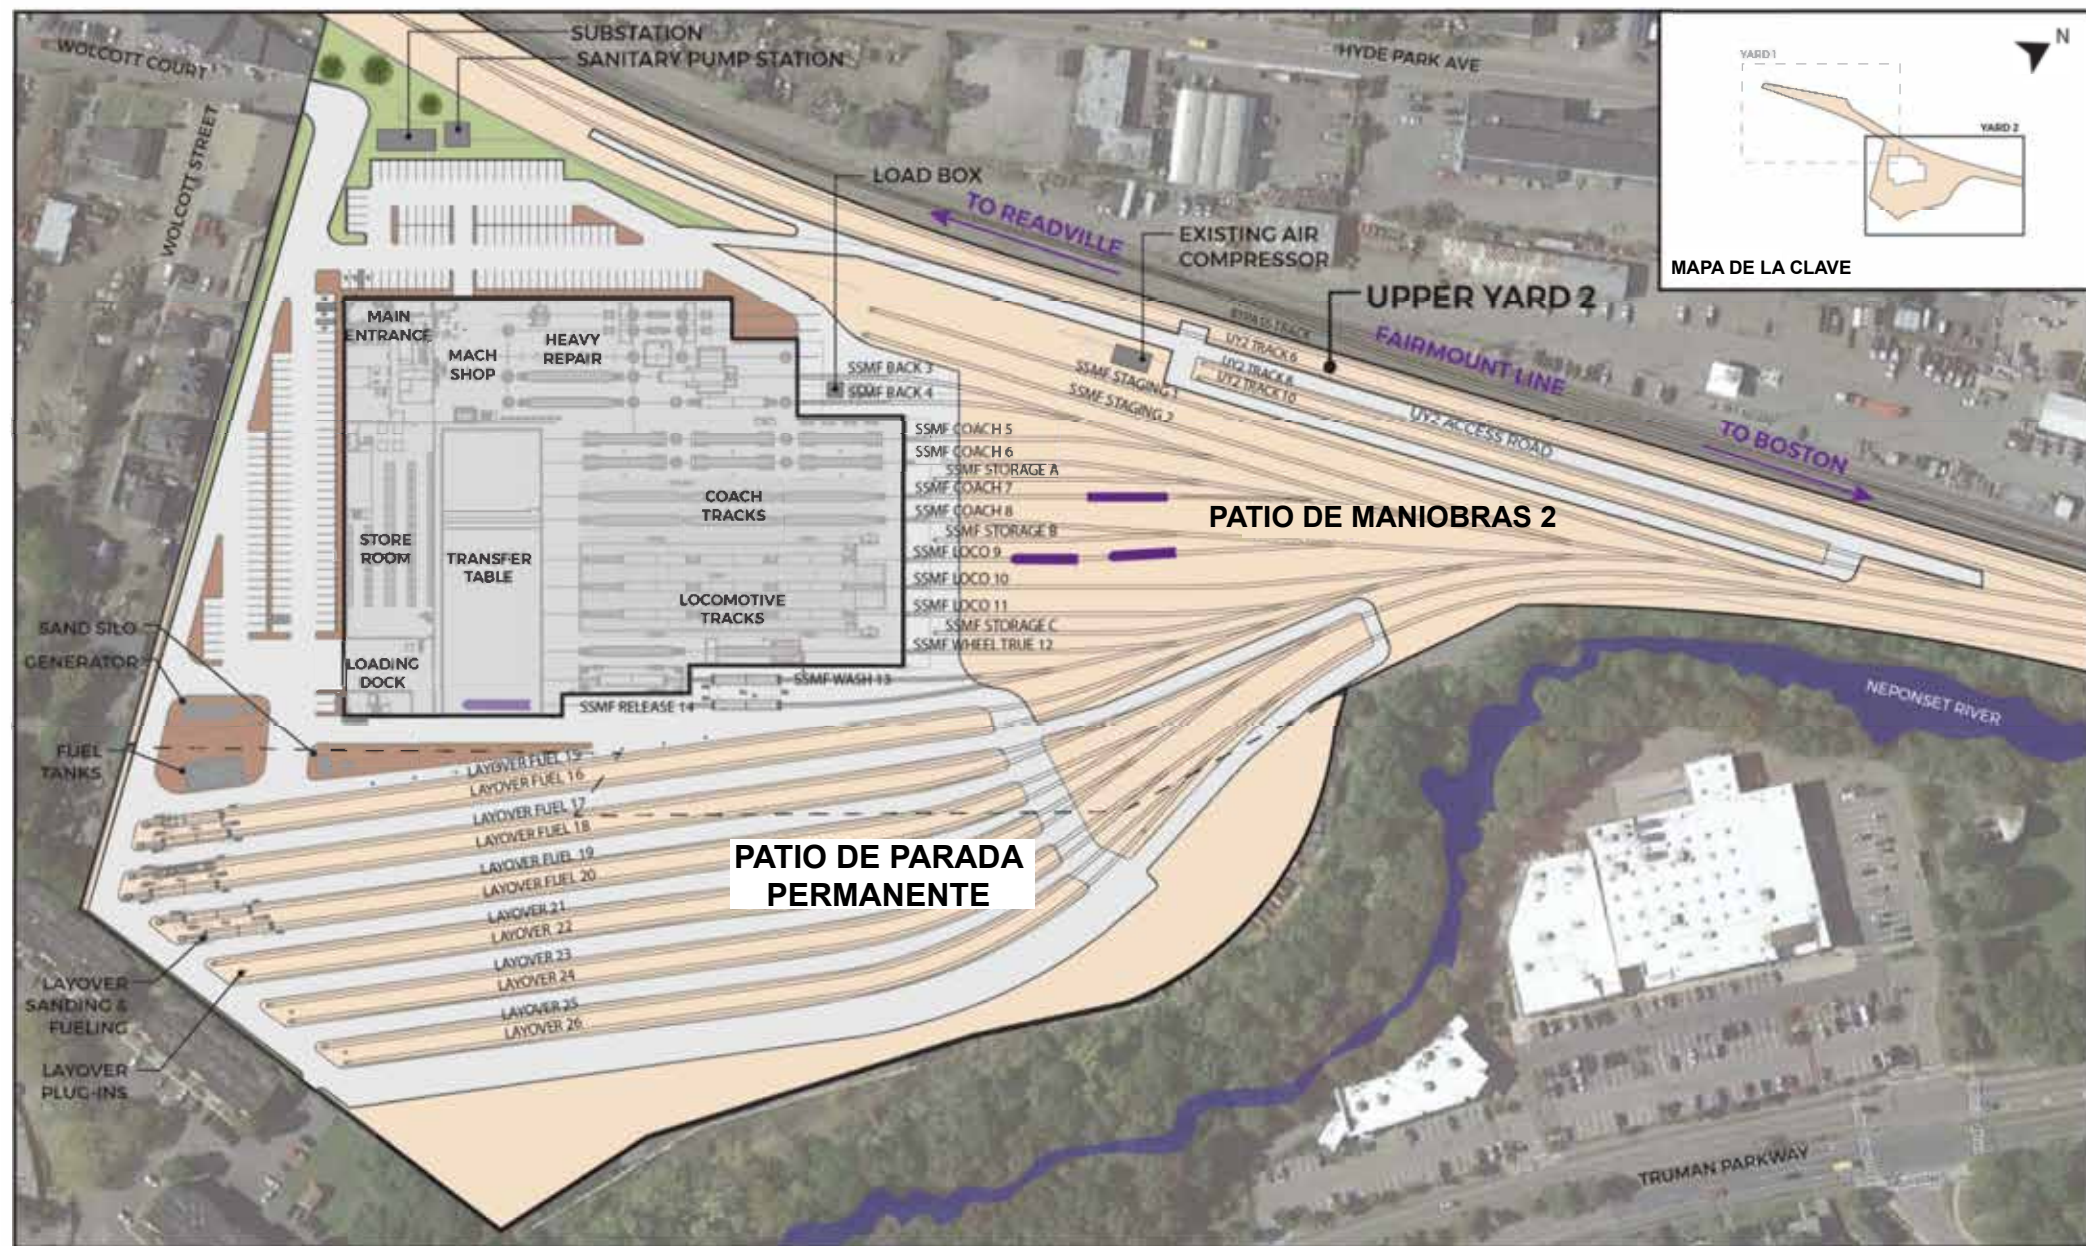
PLANO ESQUEMÁTICO DEL EMPLAZAMIENTO DEL LADO SUR DE LA INSTALACIÓN DE MANTENIMIENTO Y PARADA - PATIO 2
